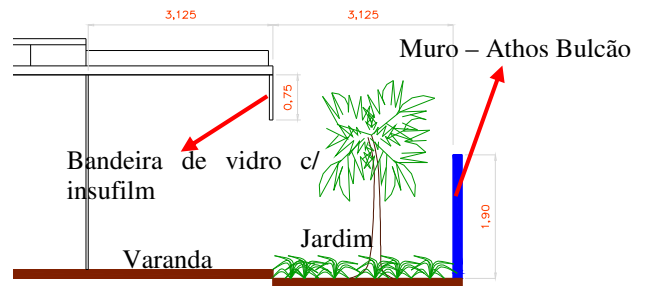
Esquema da fachada noroeste do bloco de serviços (Acervo CTRS, adaptado por LUKIANCHUKI, 2010).
